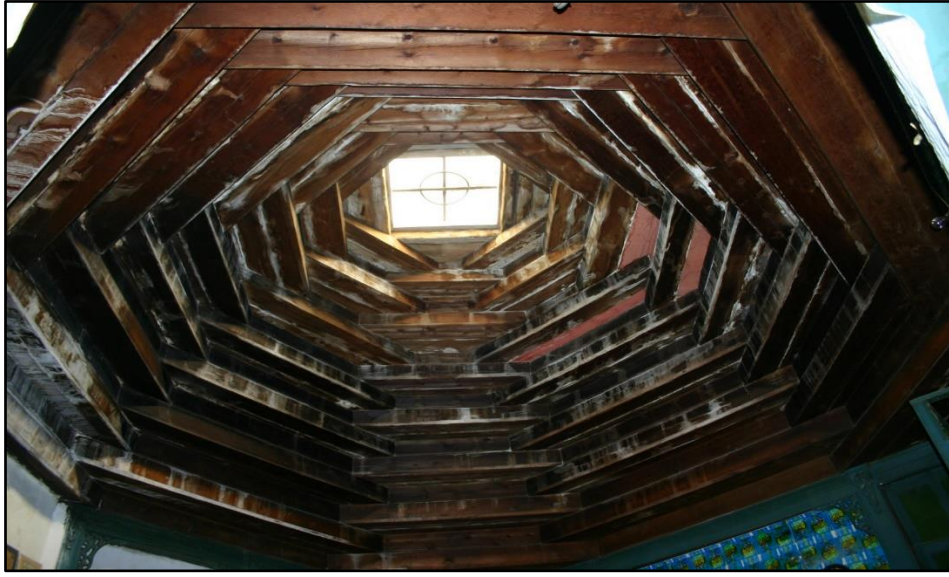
Erzurum Hanağası Evinde Kırlangıç Kubbe
